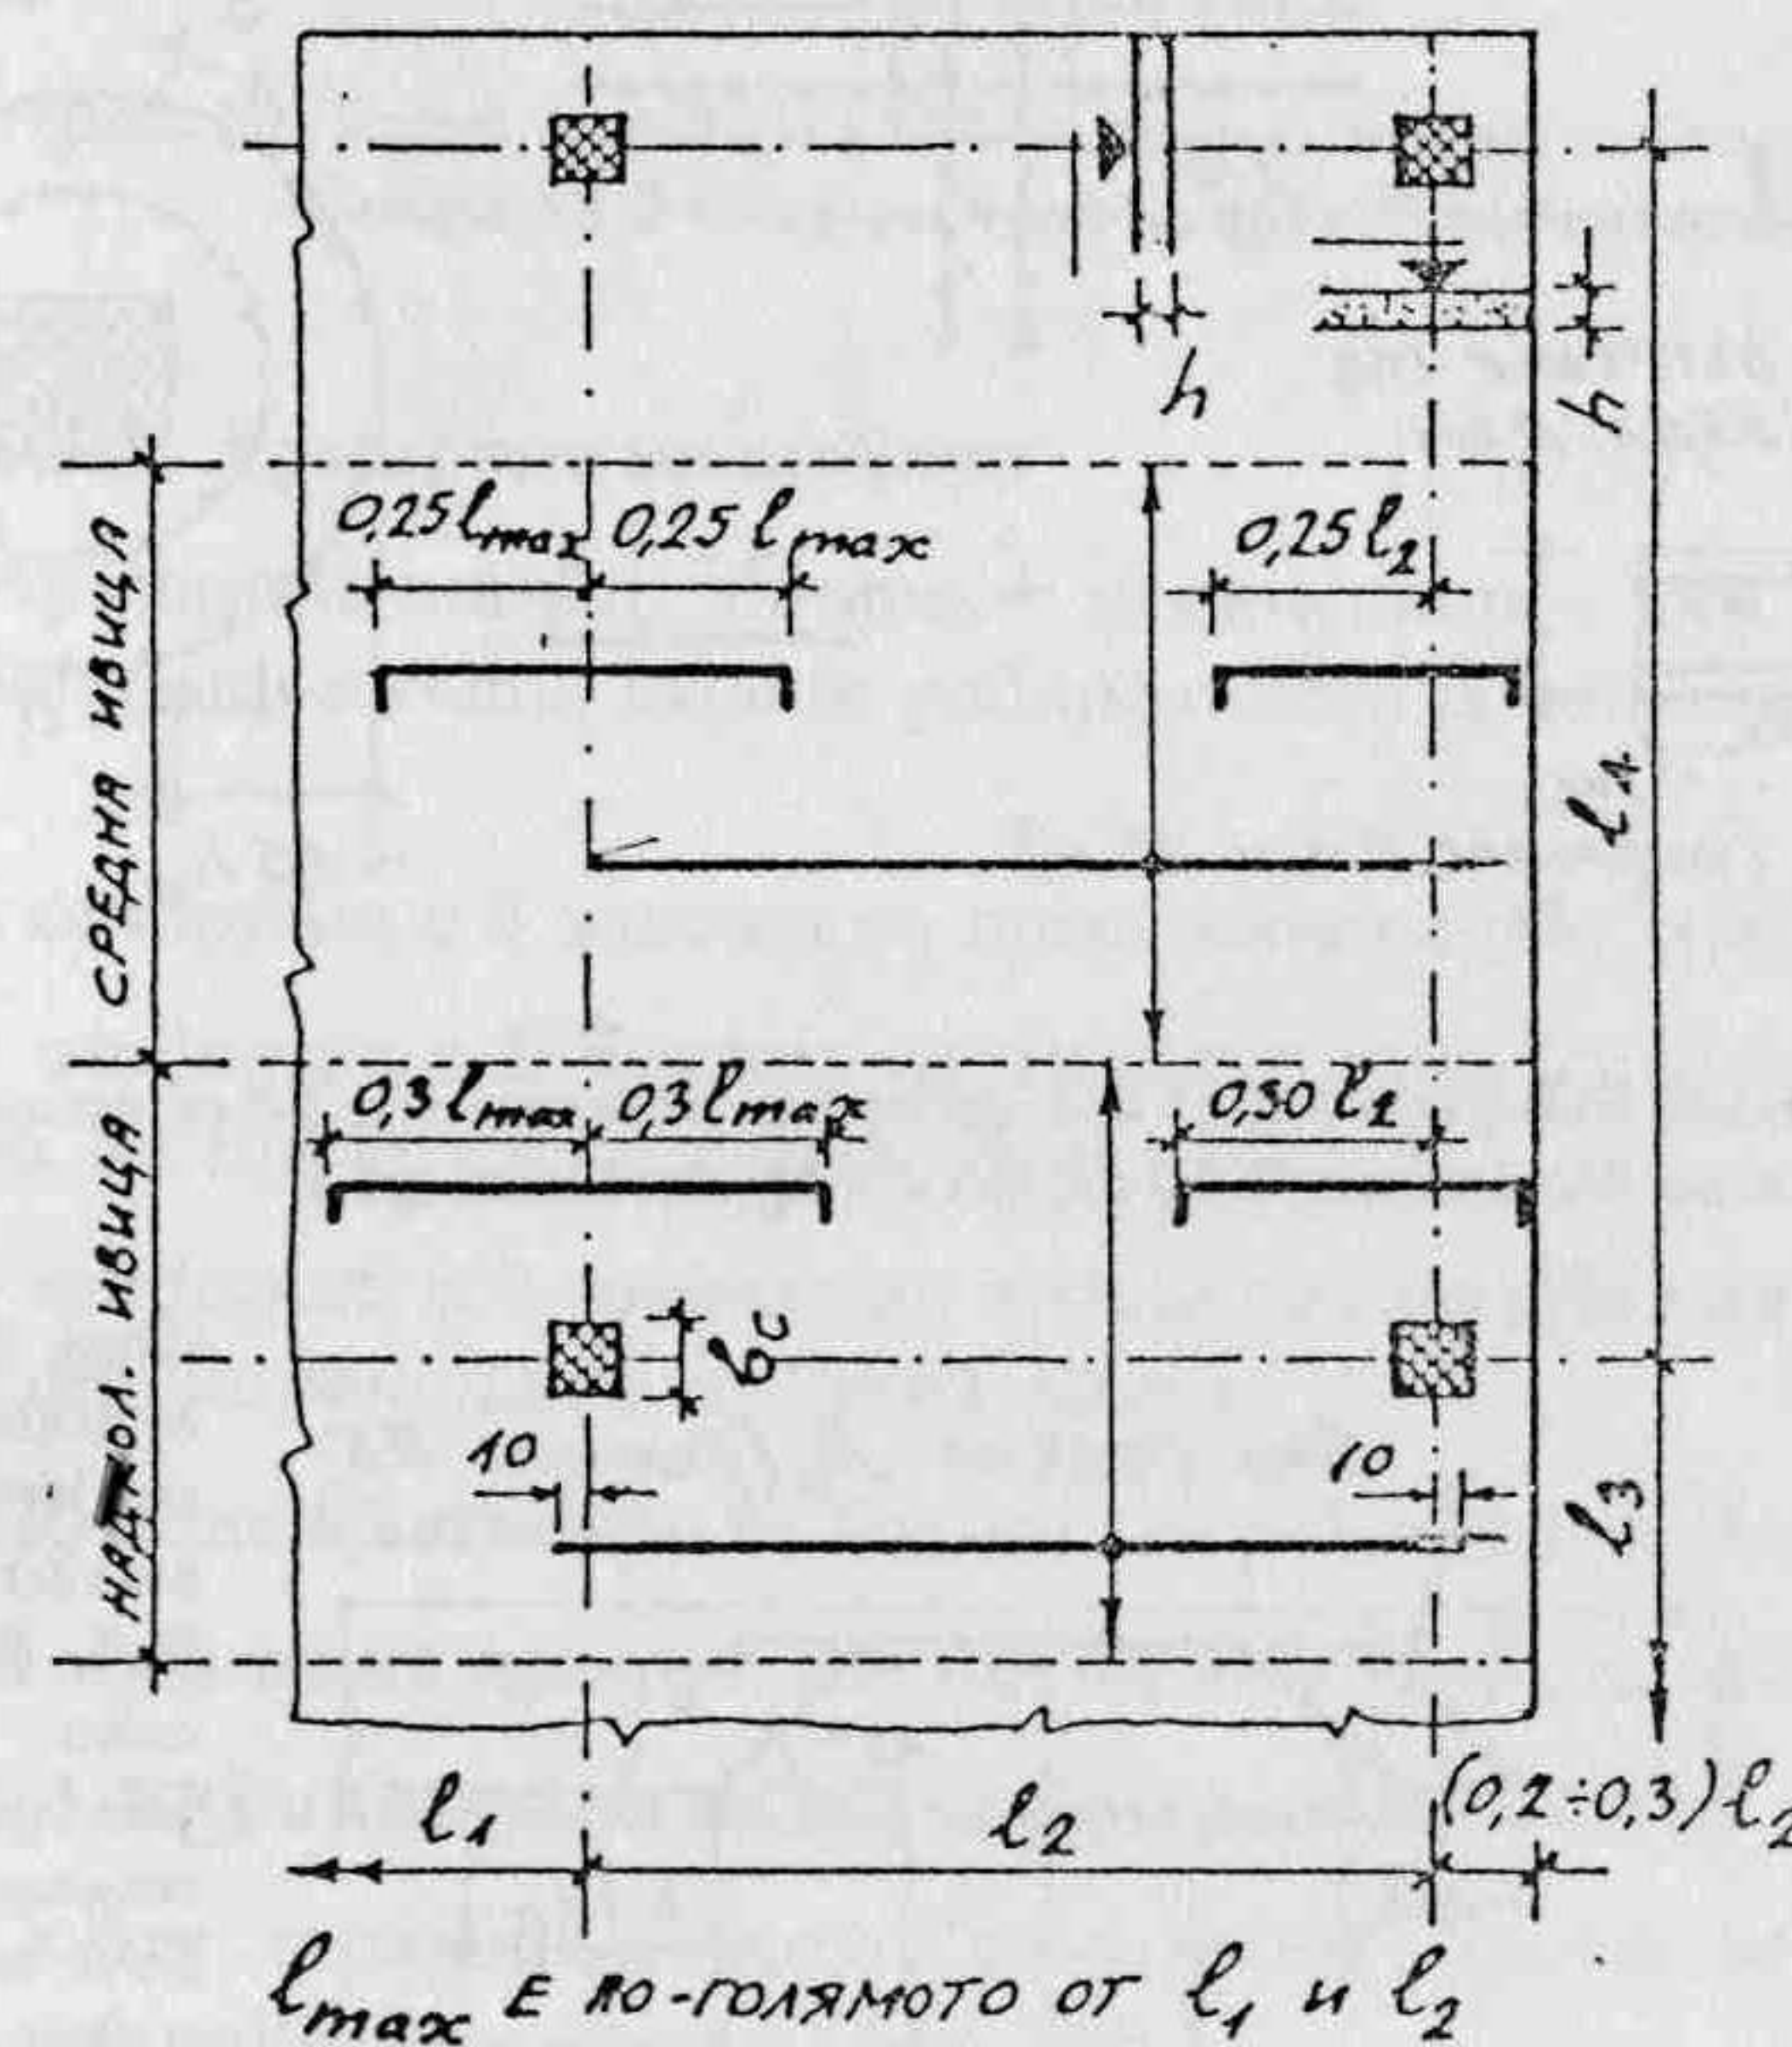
Половината от армировката за надколонна ивица се разполага в зоната на прогъвяване.
